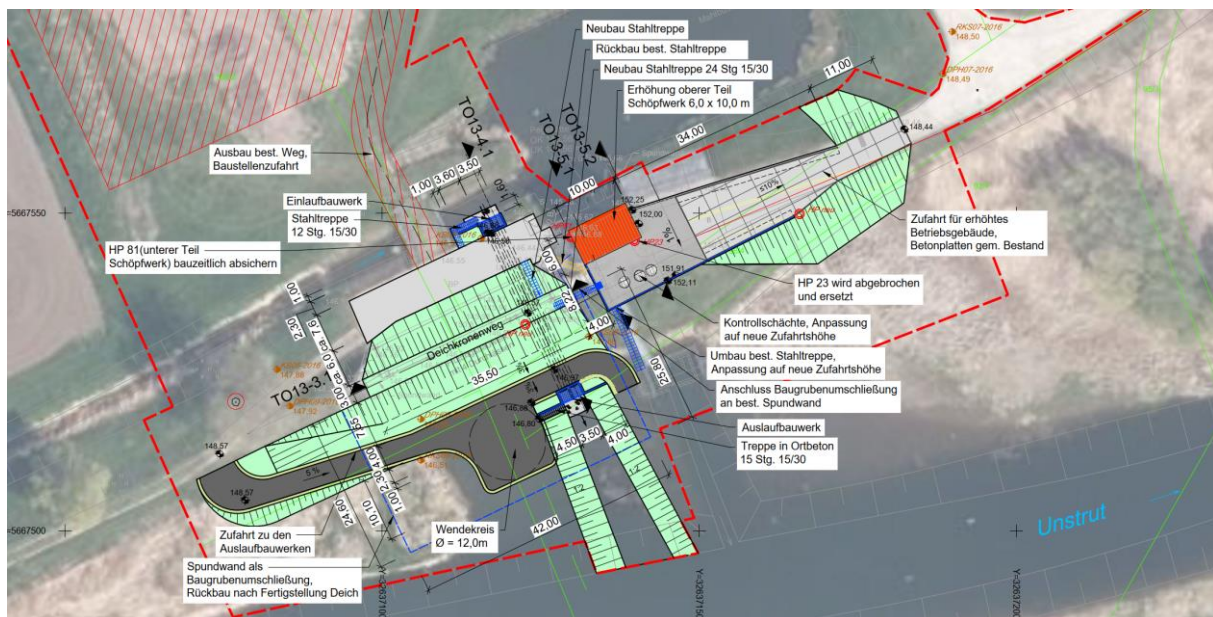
Lageplanauszug mit den geplanten Anlagen am Schöpfwerk Henschleben II
